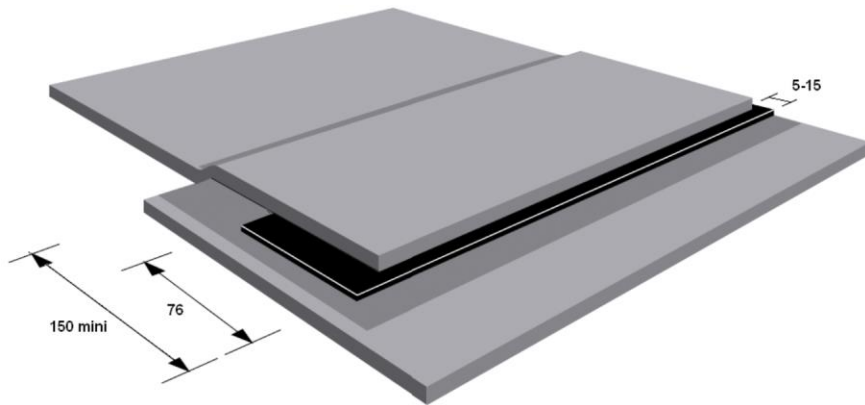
Joint bande autoadhésive en butyle - QuickSeam Splice Tape
